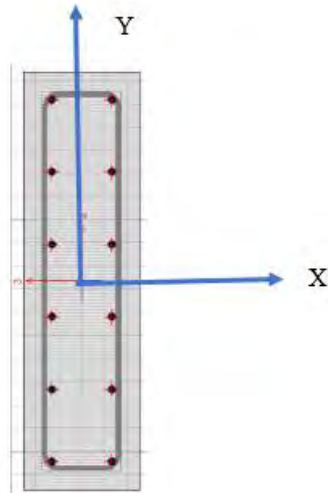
9. Sección de columna C-03 (Fuente - ETABS)
